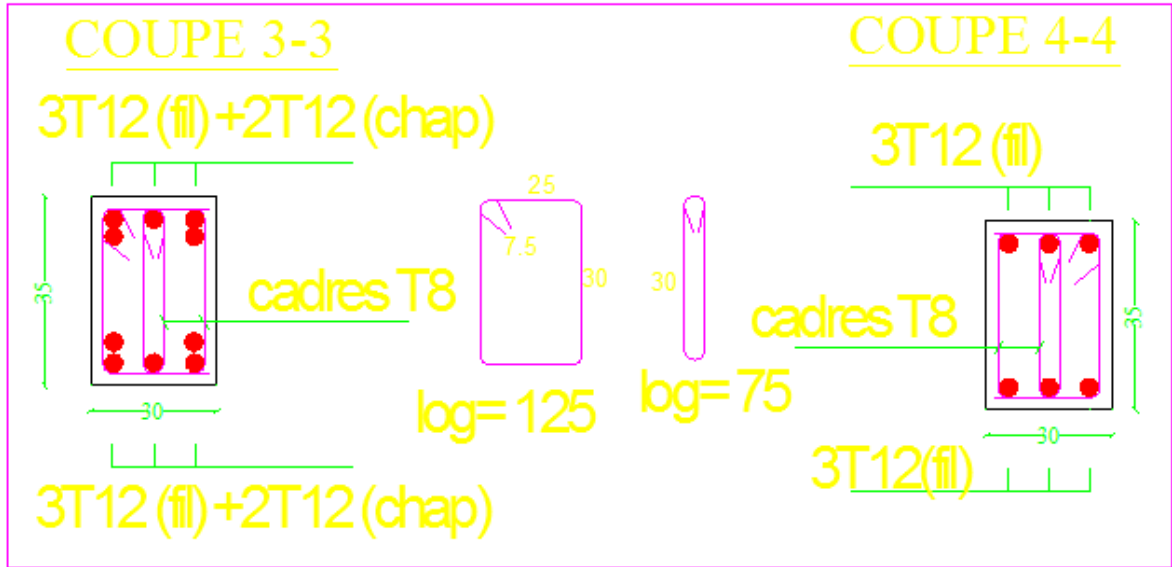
Ferraillage poutres secondaires non adhérees aux voiles
